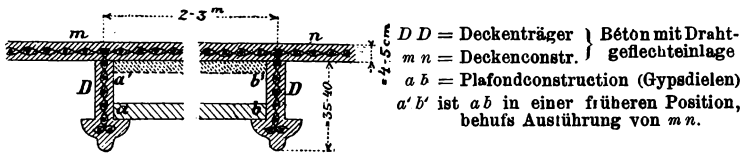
Zwischendeckenconstructionen nach System Cottançin.
